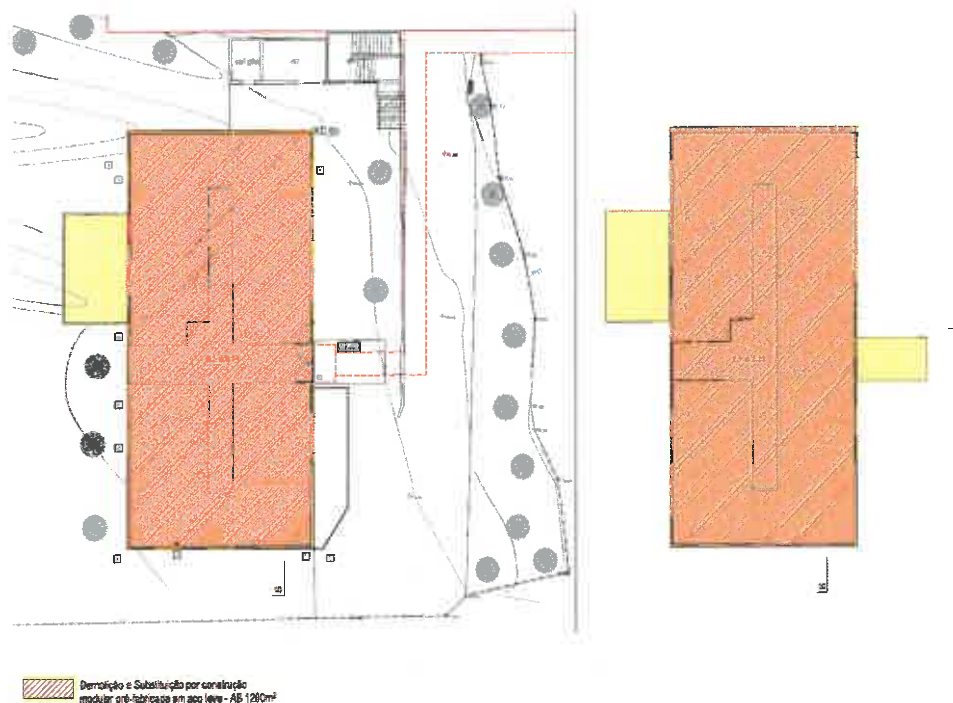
| Planta intervenção proposta - Anexos e galeria coberta proposta
